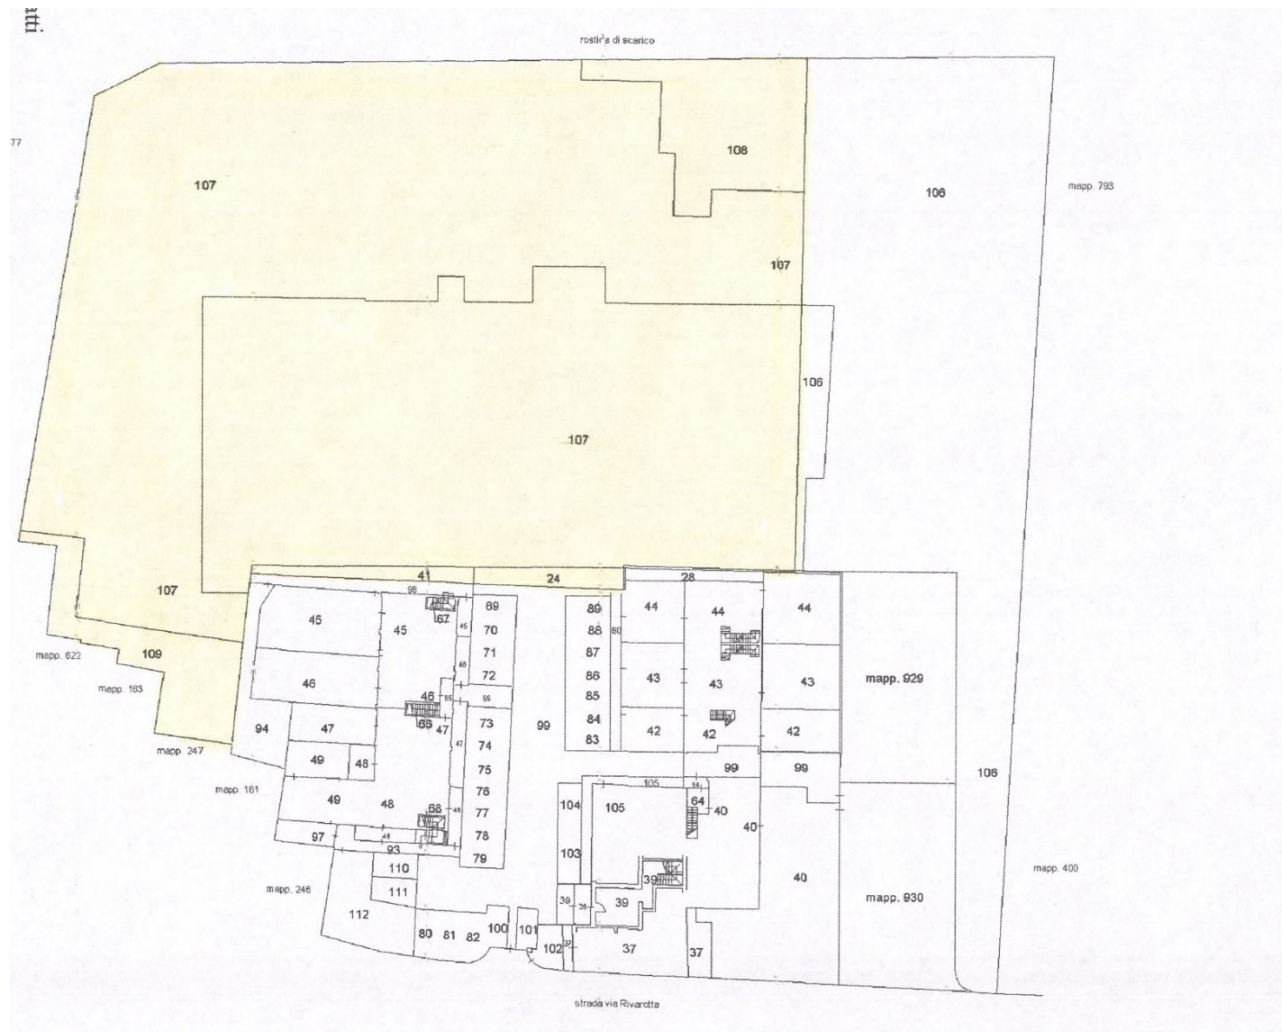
Estratto dell'elaborato planimetrico del m.n.159 foglio 26 con indicazione dei diversi subalterni presenti al Piano Terra
